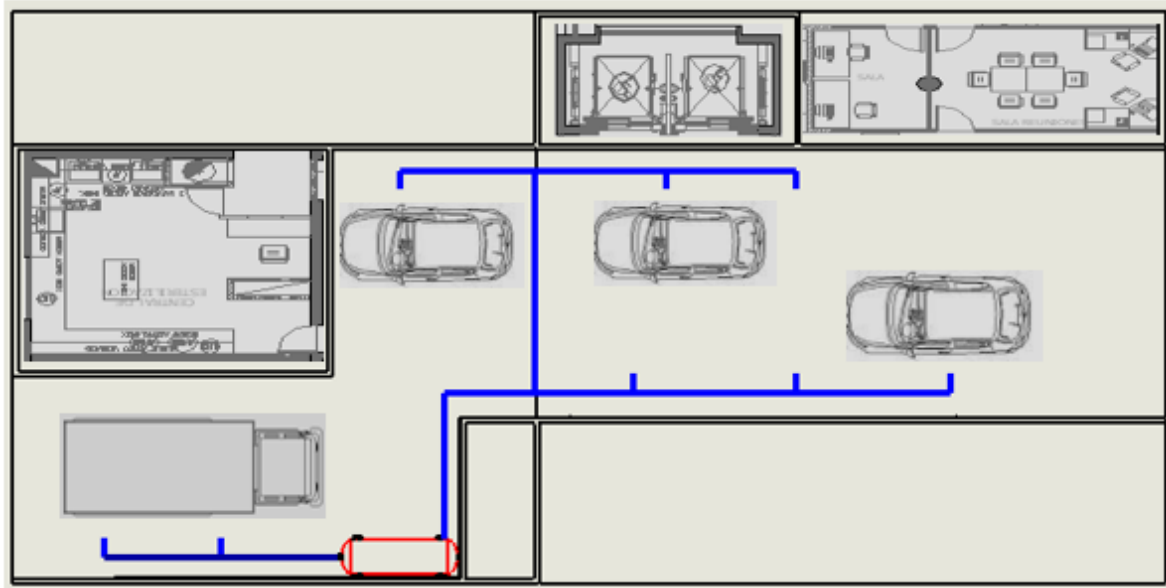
Vista en planta de la red de aire comprimido. Fuente (Elaboración propia, 2019)
